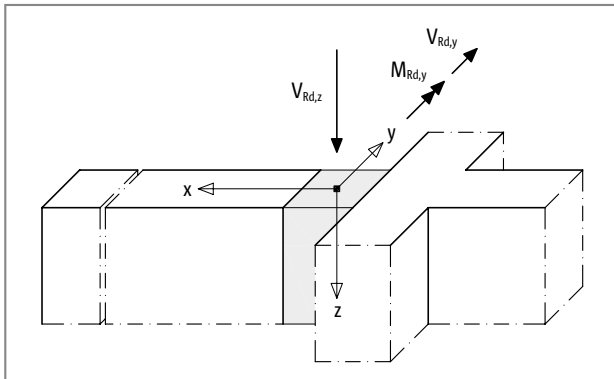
Schöck Isokorb® Typ WXT: Vorzeichenregel für die Bemessung
